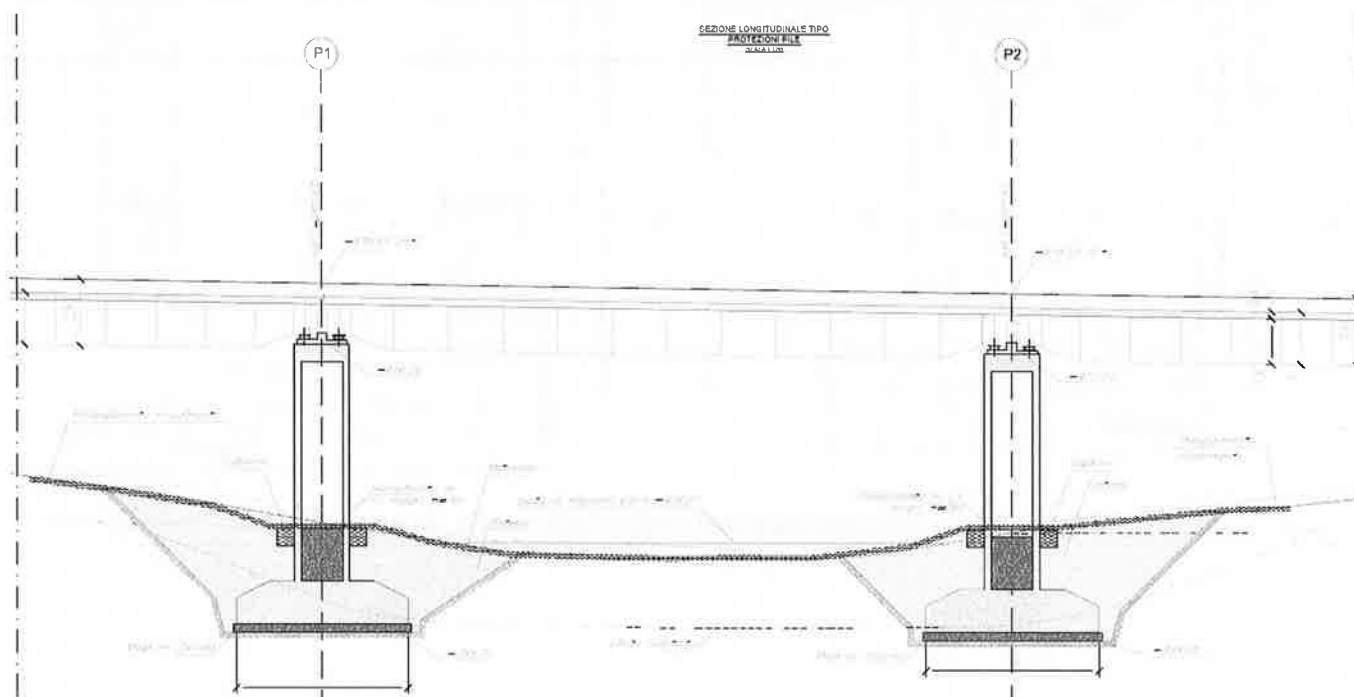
Sezione longitudinale protezione antiscalzamento pile – Bonorva VI02
